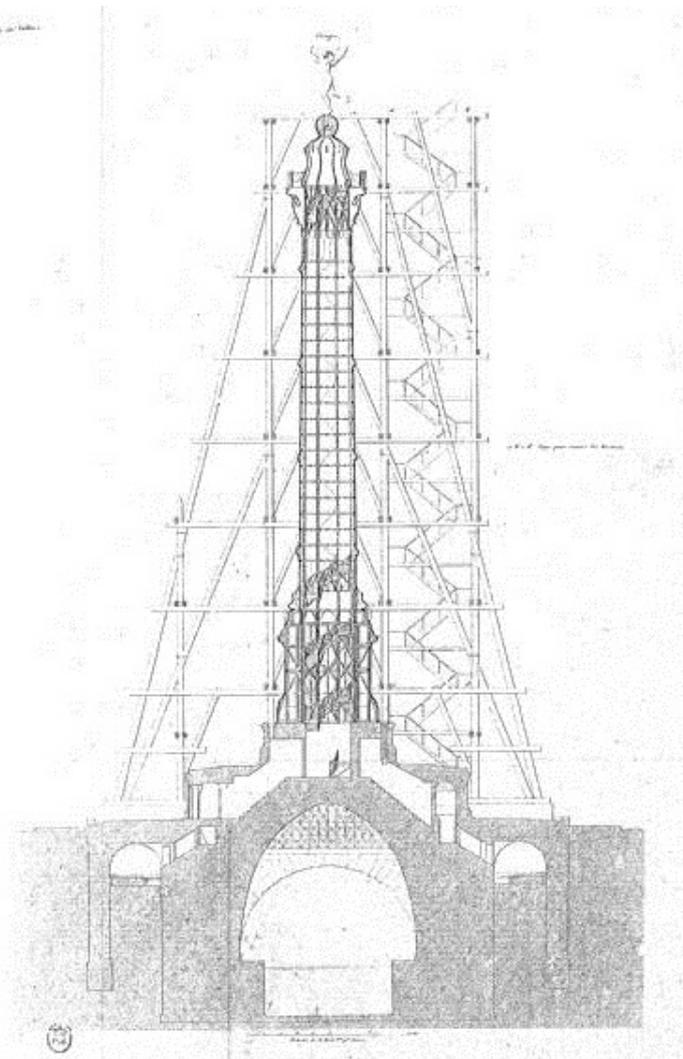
et 23 - Coupe de la colonne et des substructures (canal et caveaux).
